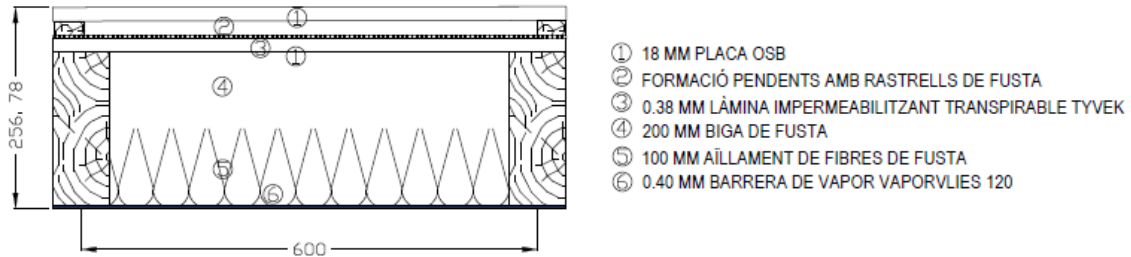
Secció coberta plana transitable (balcons de planta primera). Font: Pròpia.
